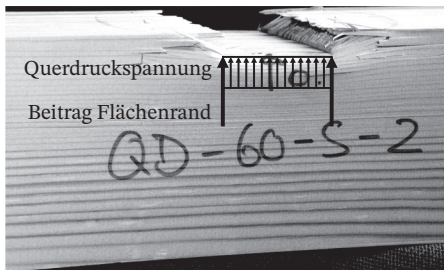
Beitrag des Flächenrands zur Querdruckbeanspruchbarkeit am Vollholzbalken (Quelle: Versuchsanstalt für Stahl, Holz und Steine, Karlsruhe, Lehrstuhl für Ingenieurholzbau und Baukonstruktionen).
